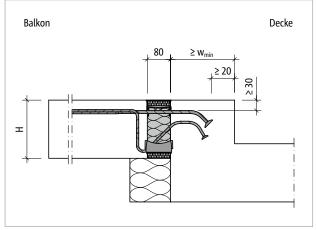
Schöck Isokorb® T Typ KL-O: Balkon mit Höhenversatz nach oben und Außendämmung
